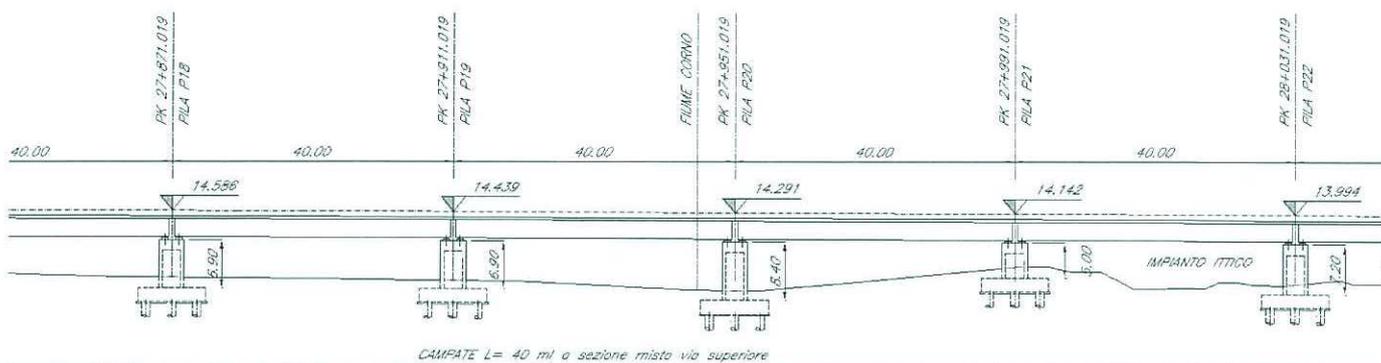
Prospetto dell'attraversamento del fiume Corno.
